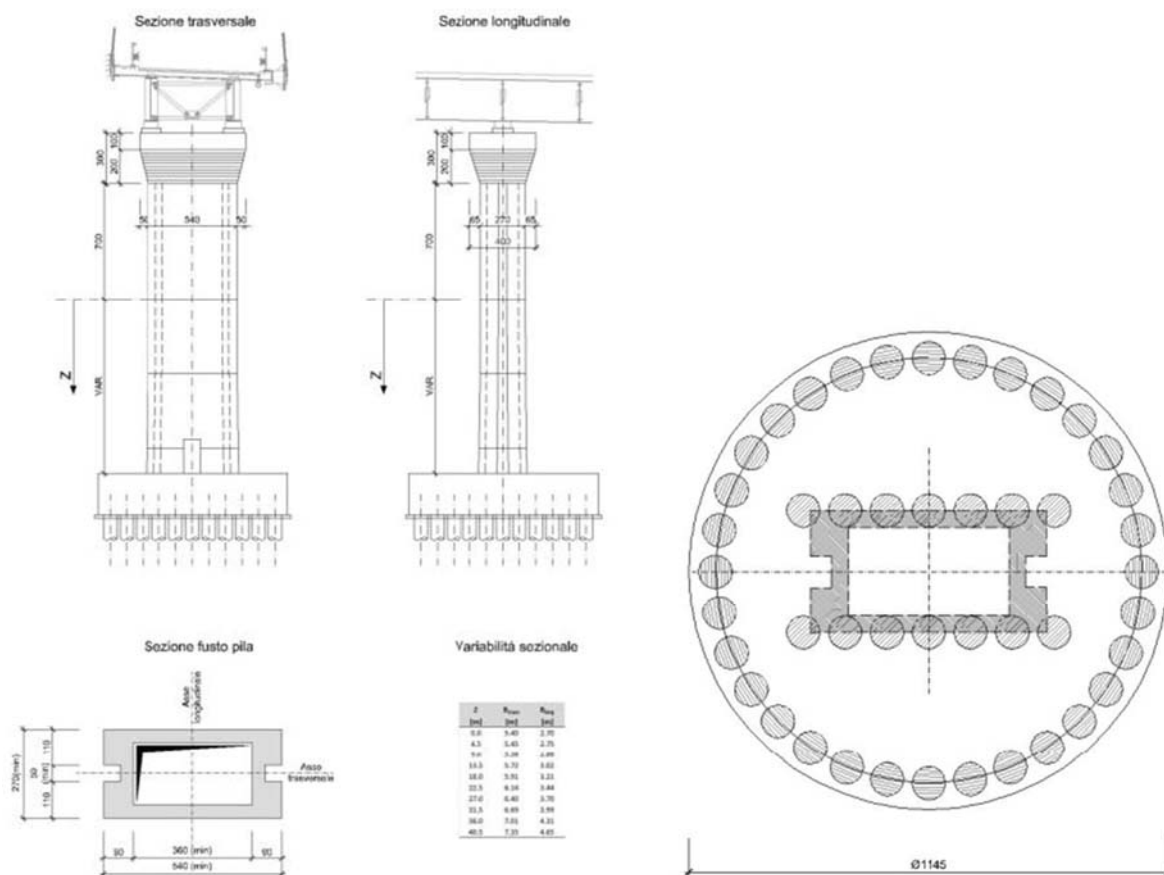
Inquadramento generale geometria pile e fondazioni Viadotto B
